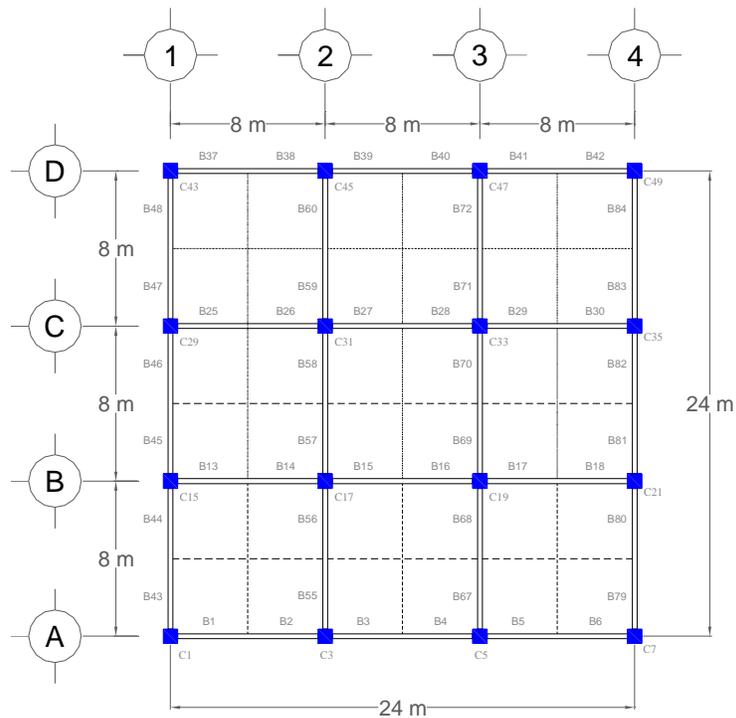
Planta tipo del edificio de 17 niveles
